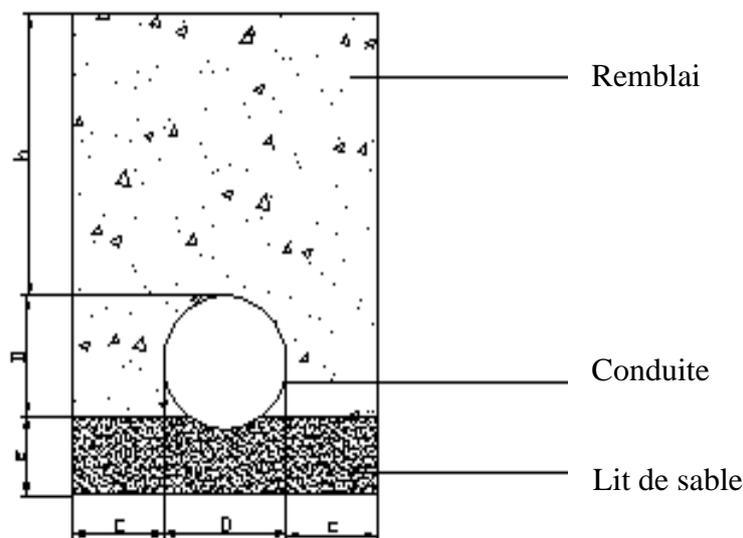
coupe transversale d'une tranchée avec la mise en place de la conduite
